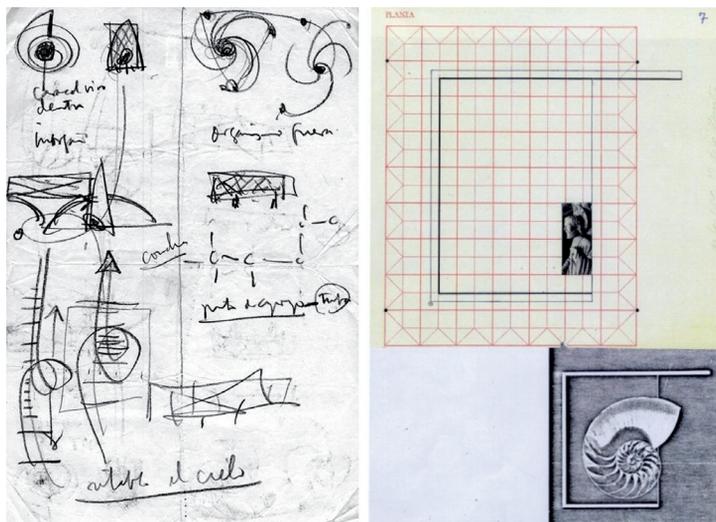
Oteiza, Jorge: *Arte y religión*. Archivo FMJO, reg.19041. Panel del concurso con planta de la Capilla.
